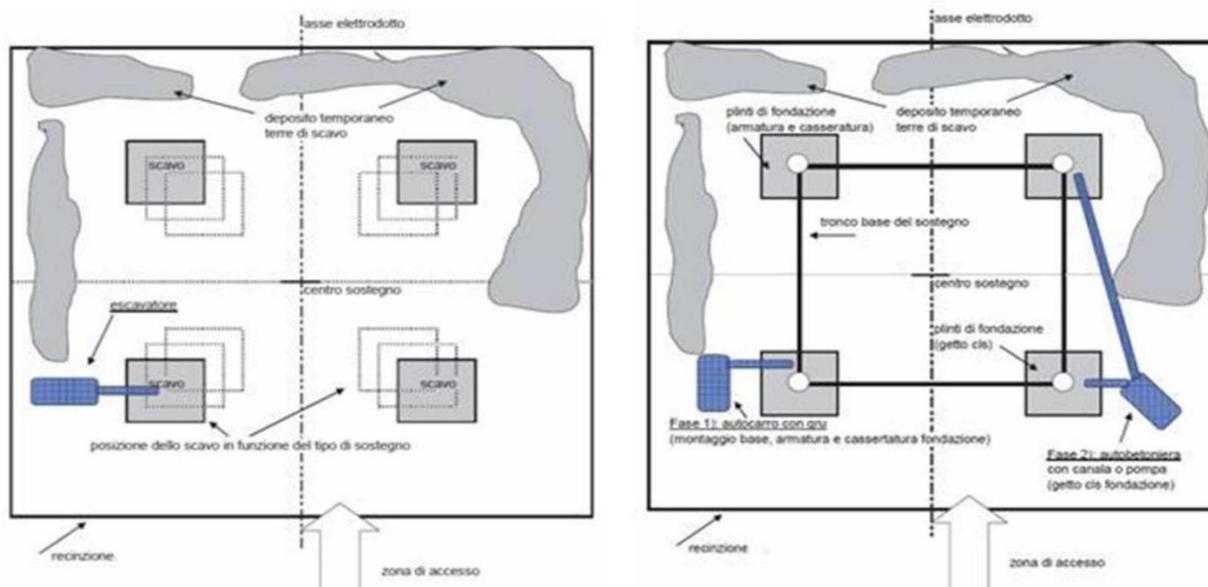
Planimetria tipologica di un microcantiere per una fondazione superficiale: a sinistra nella fase di scavo delle fondazioni; a destra nella fase di getto per la realizzazione dei plinti di fondazione.
